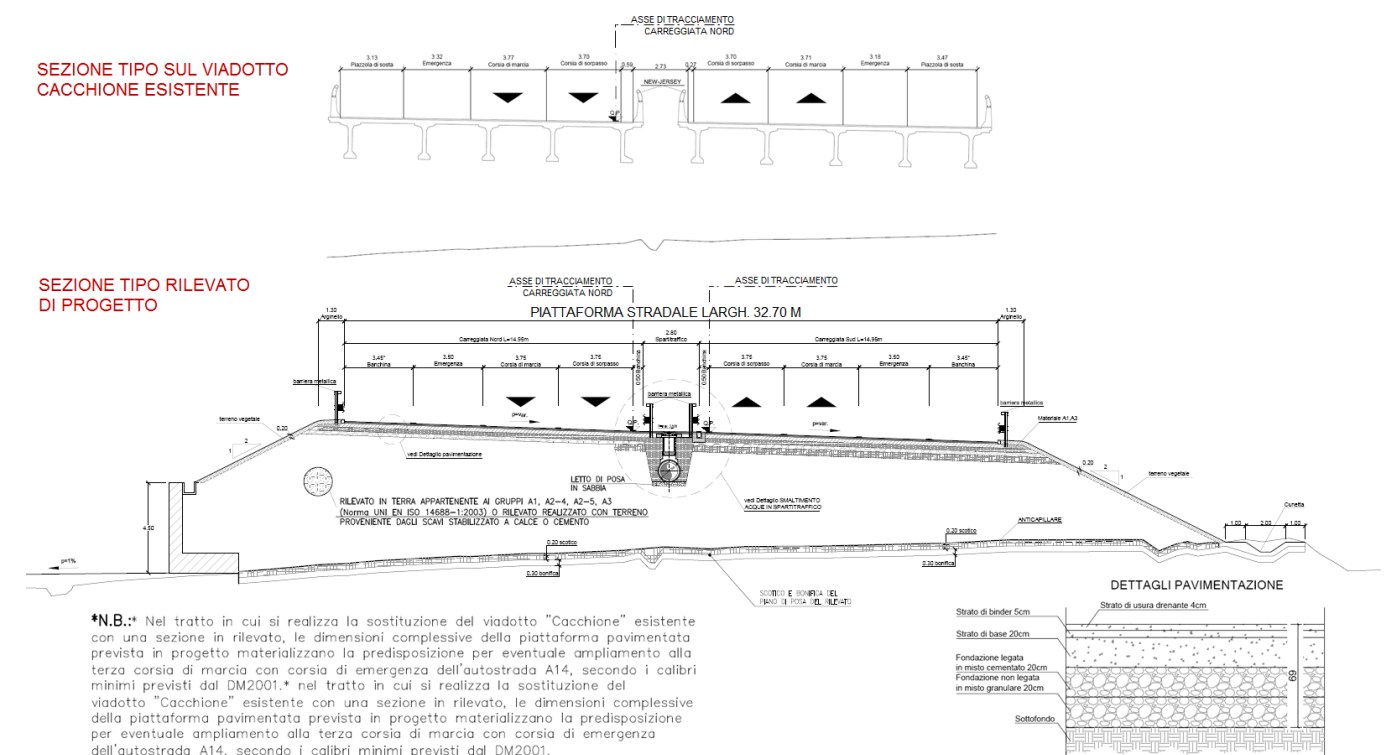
CONFRONTO TRA SEZIONE TIPO ATTUALE E DI PROGETTO
